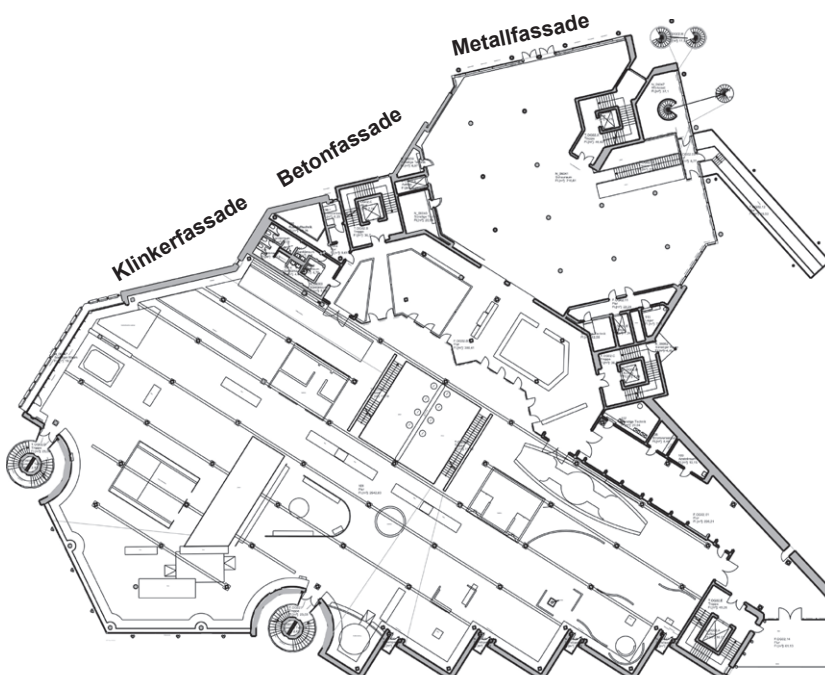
Grundriss Haupthaus 2. Obergeschoss auf der Ebene + 43,97 m üNNH
